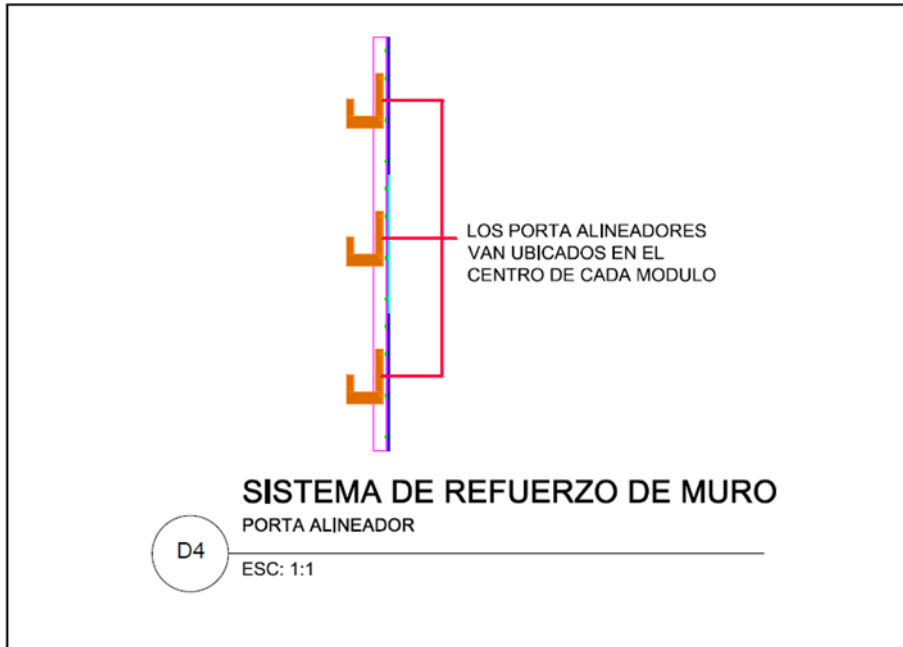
Sistema de refuerzo de muro (Modulación Vertical)
